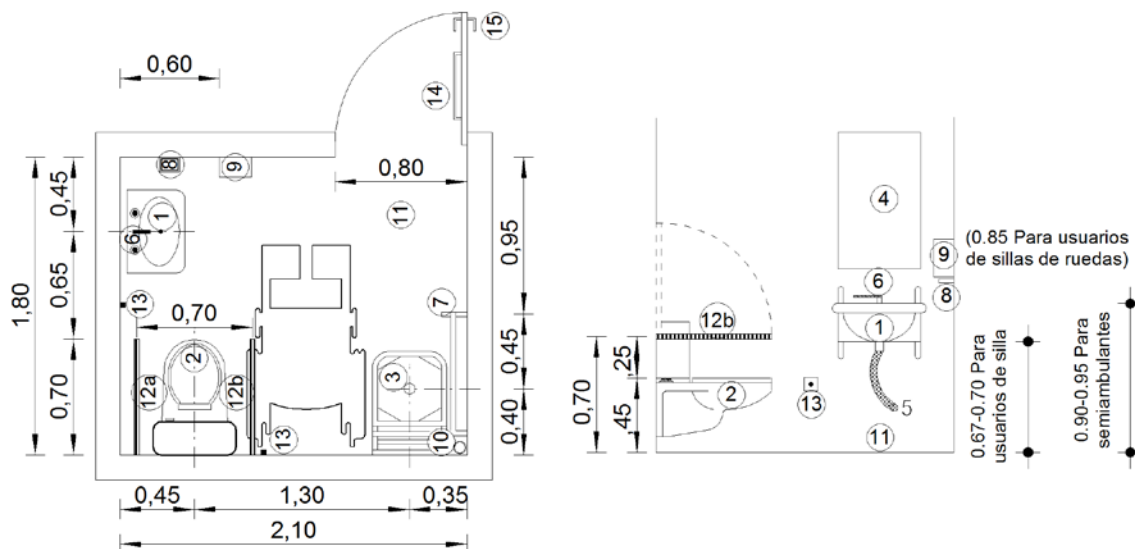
Simbología de los elementos de un baño en planta y elevación
